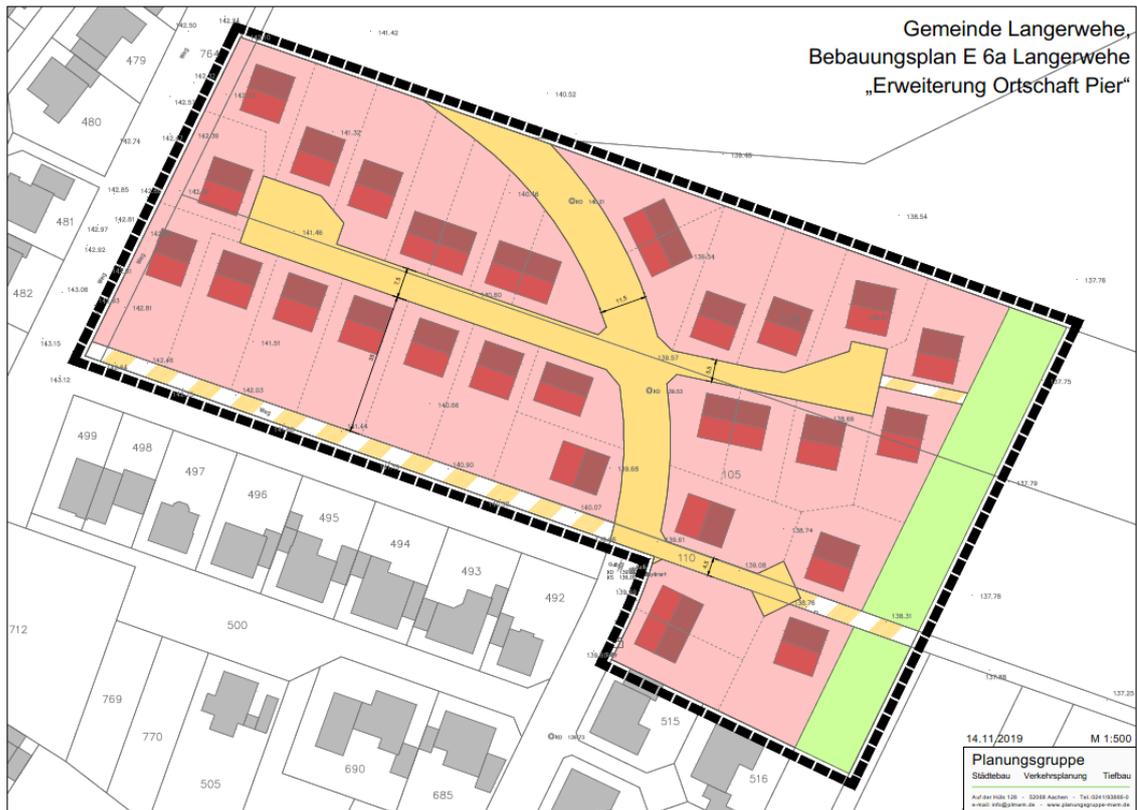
zugrundeliegendes Konzept Bebauungsplan Nr. E 6a
